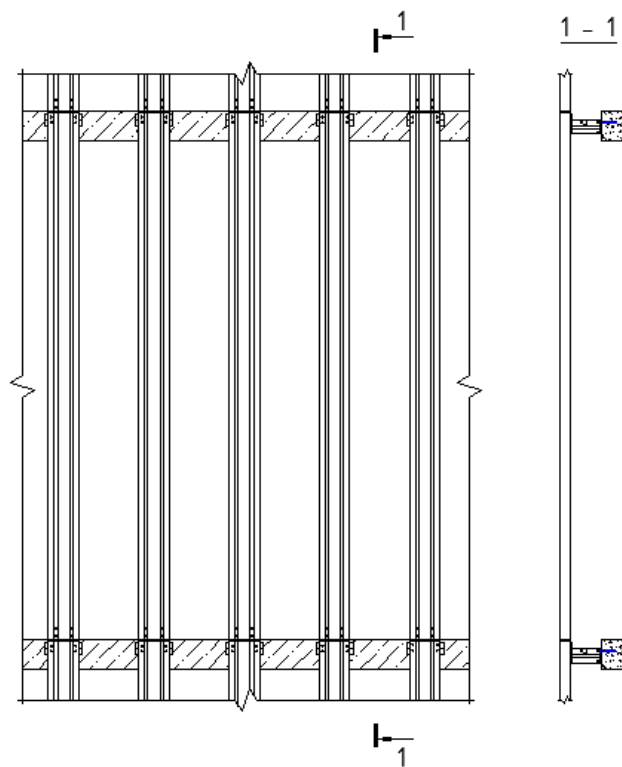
Система крепления в межэтажные перекрытия на основе кронштейна КНс-27
